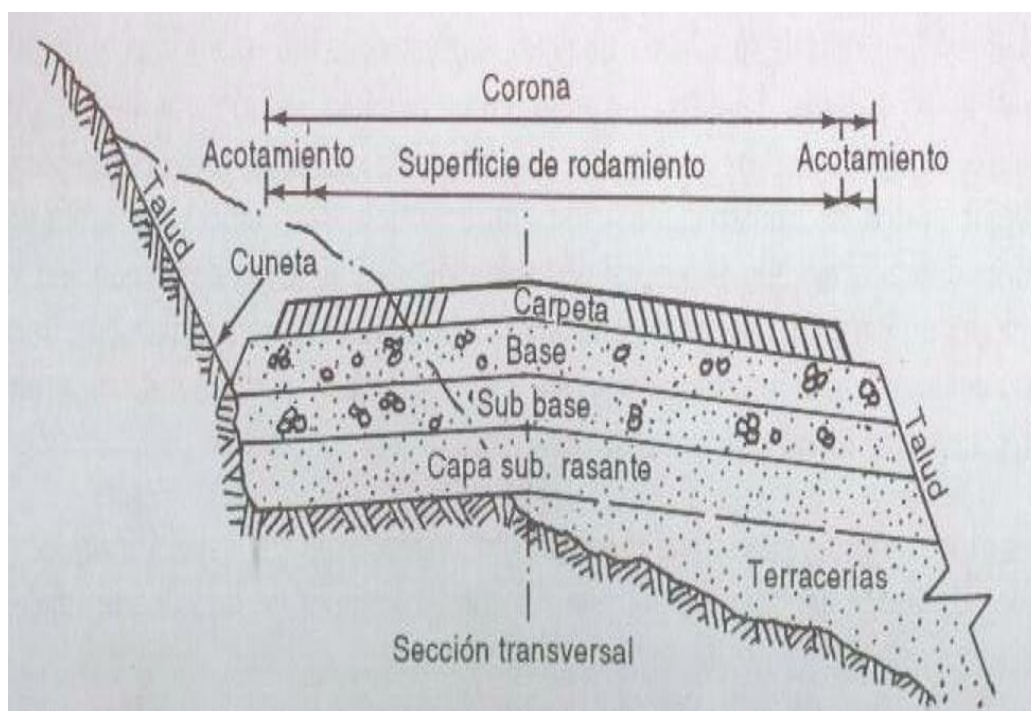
COMPONENTES ESTRUCTURALES DE UN PAVIMENTO FLEXIBLE
